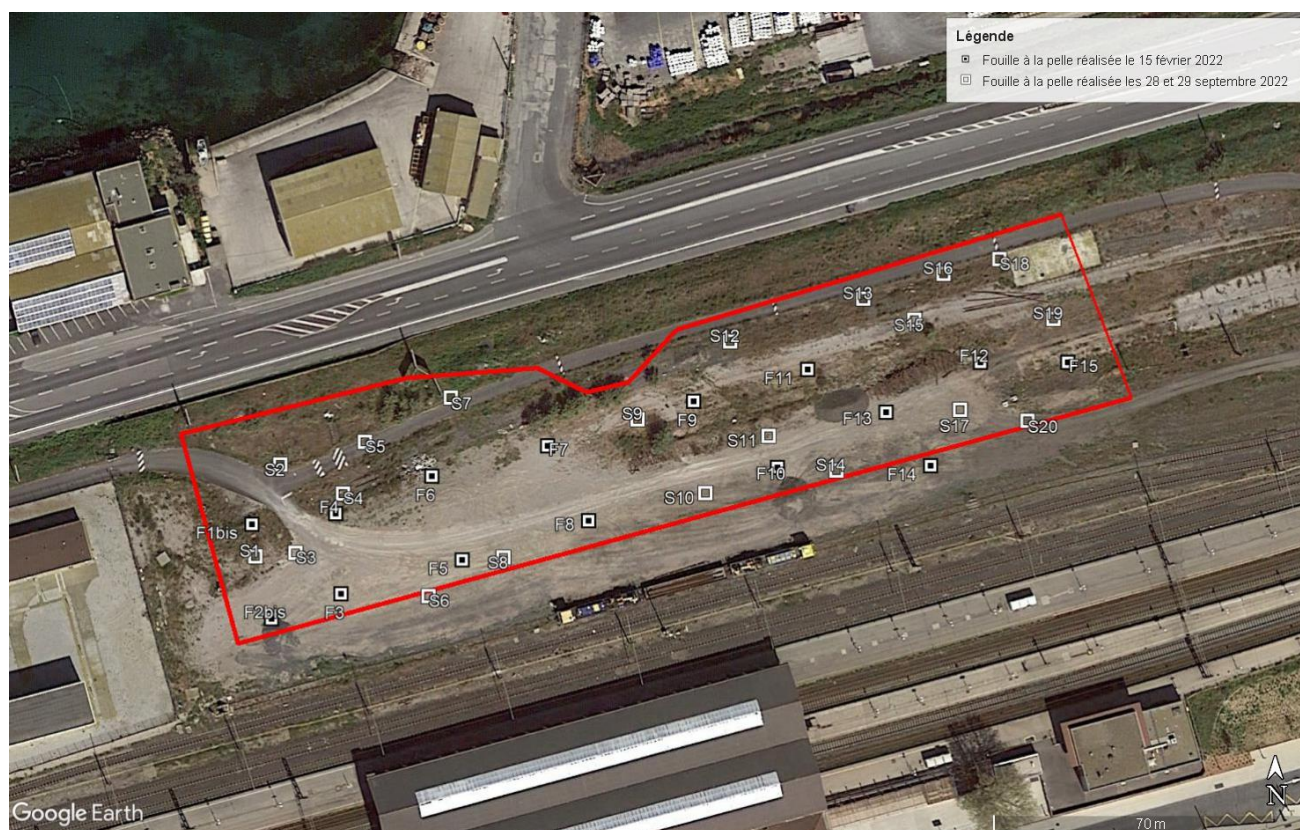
Plan d'implantation des fouilles sur photographie aérienne
